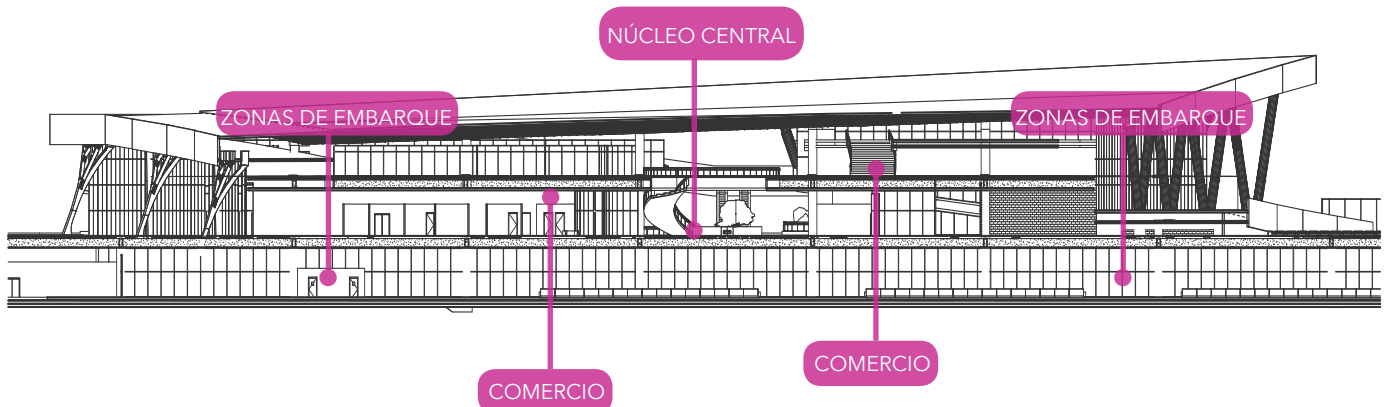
Corte Transversal CIMU Fuente: Proyecto arquitectónico CIMU
